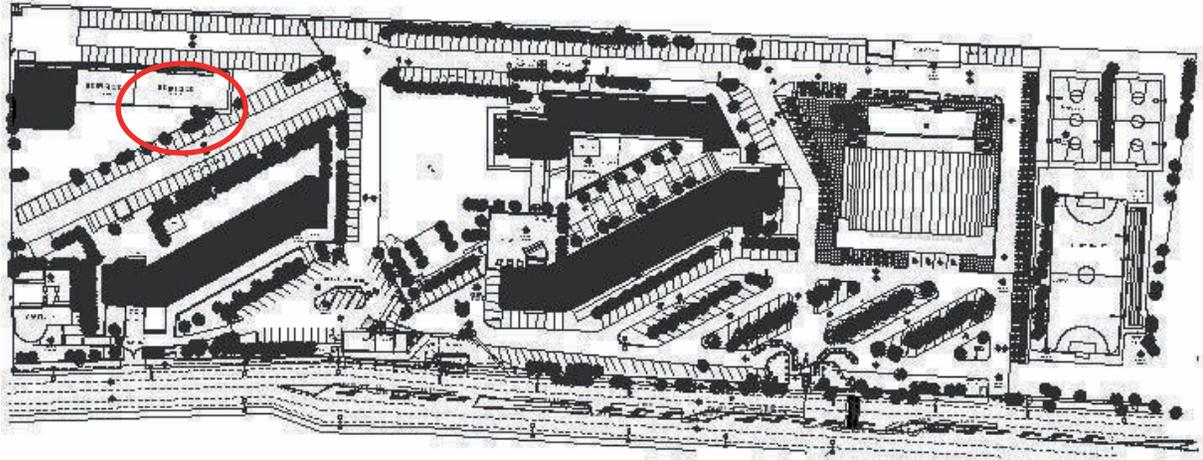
Vista aérea de la UVAQ (dentro del círculo se ubican los talleres de carpintería, herrería y maquetas).
